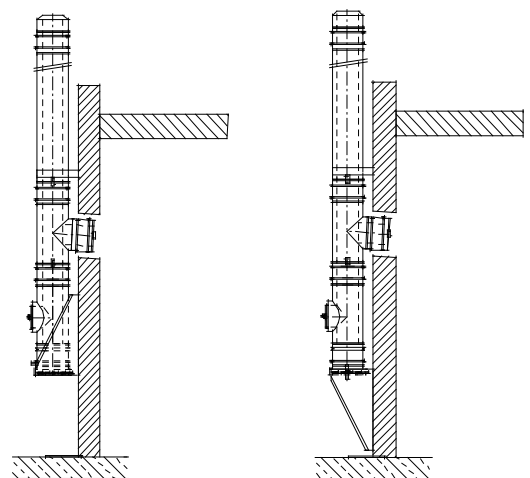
Aufbau Grundplatte mit Kondensatablauf und Konsolblech nach oben
